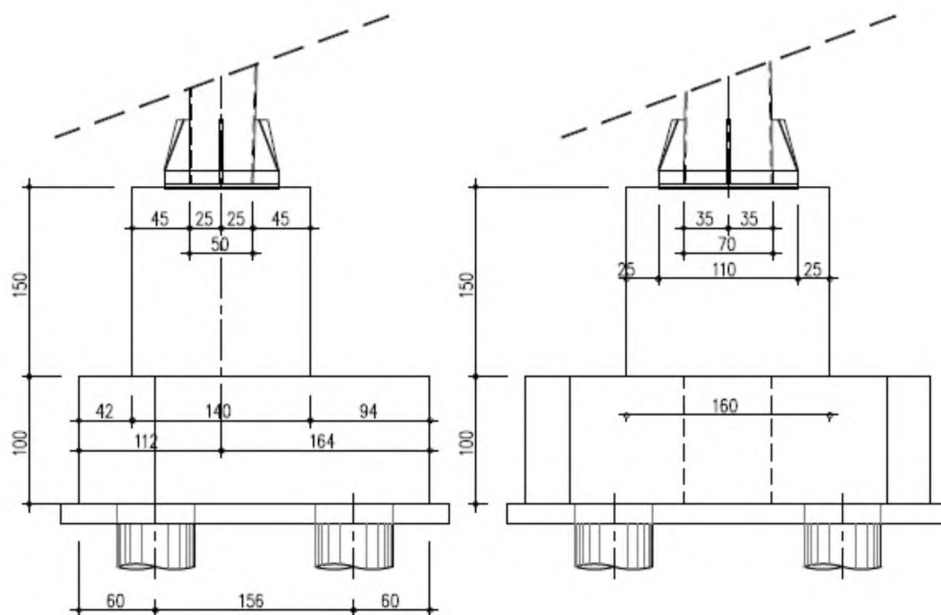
Sezioni del plinto di fondazione - posa su rilevato
